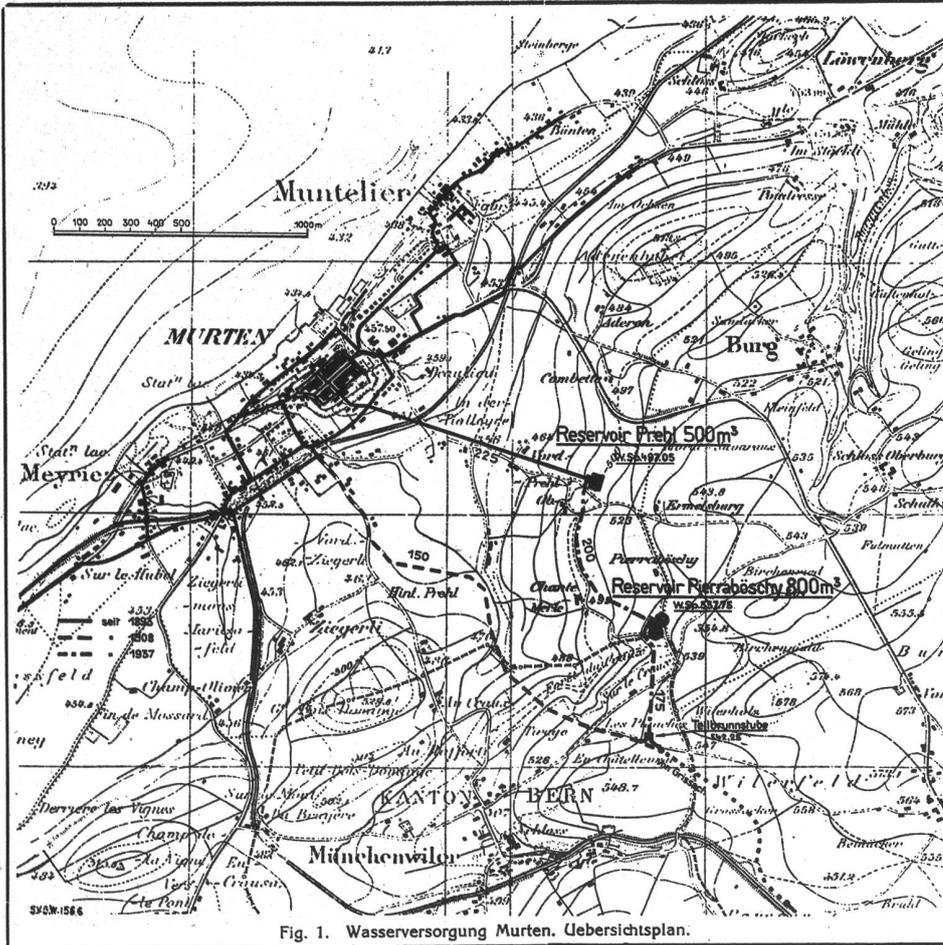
Wasserversorgung Murten. Uebersichtsplan.
